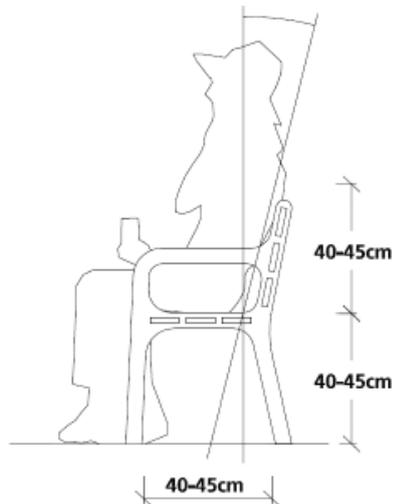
Banco accesible (fuente: Plan de Accesibilidad universal en el municipio de Málaga)
